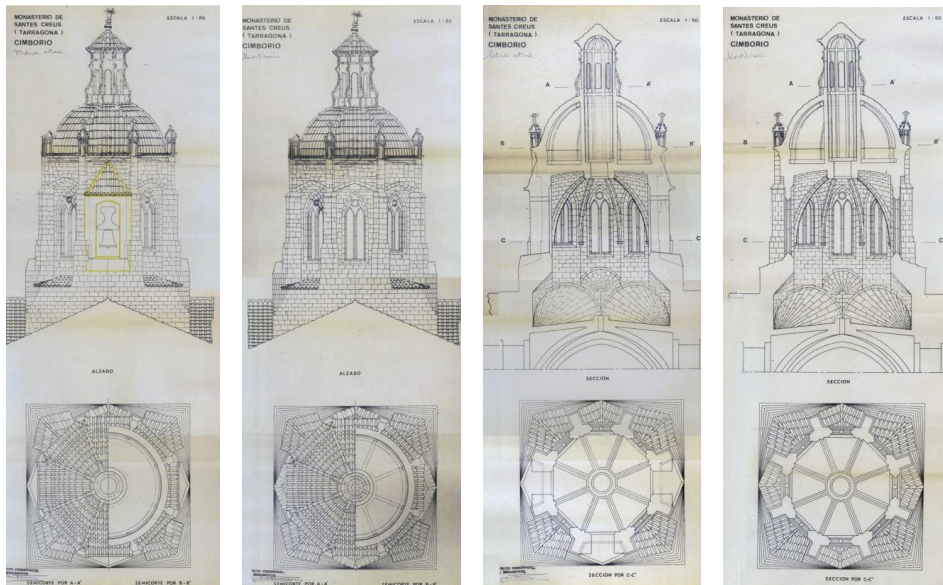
Aiguamúrcia. Monasterio de Santes Creus AAFV. Planos de proyecto. Plantas, alzados y secciones del cimborrio. Estado inicial y propuesta de intervención
